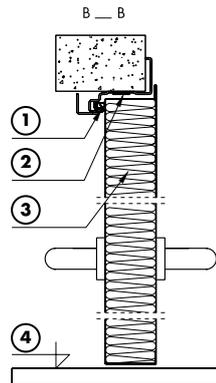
Vertikalschnitt Stahltüren mit Eckzarge.
